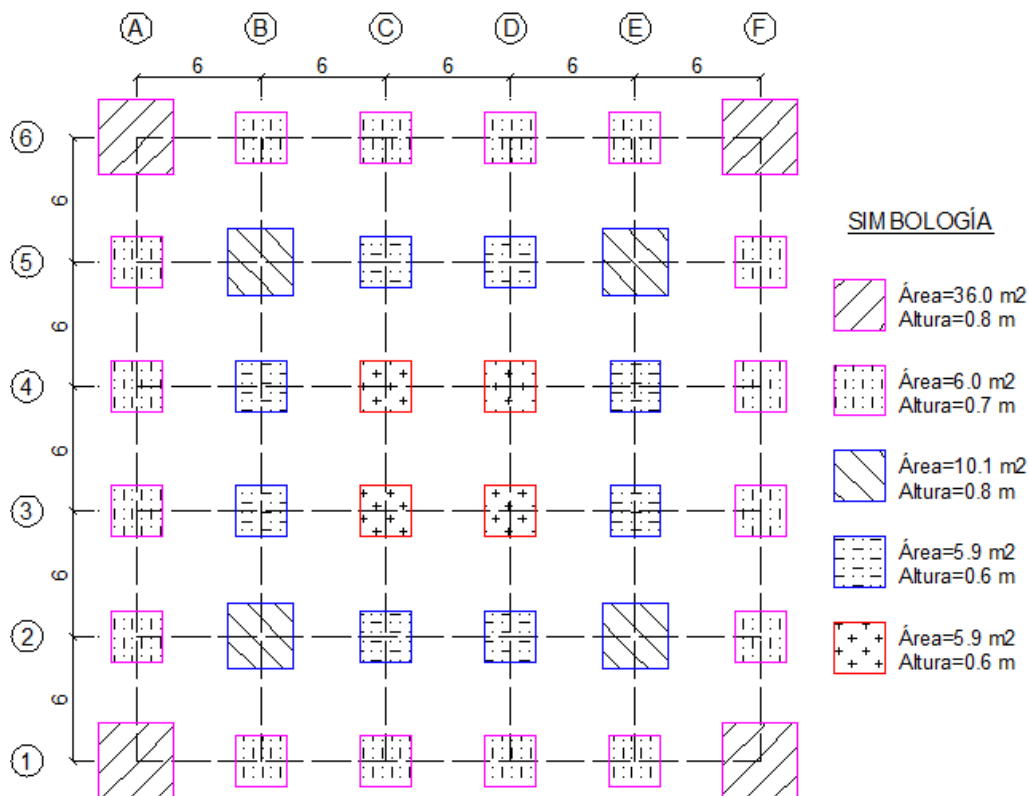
Plano de cimentaciones de la Variante 1 para la edificación de 5 niveles.
